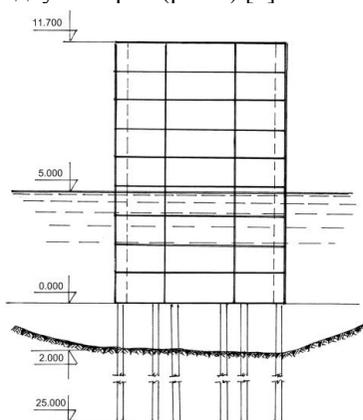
Размыв грунта у железобетонной опоры (реконструкция)
